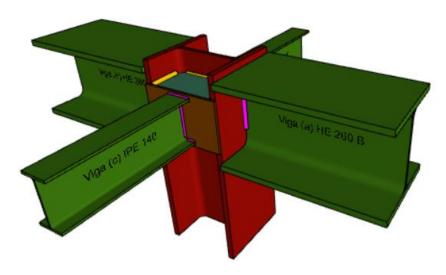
Unión encuentro pilar- cuatro vigas segunda planta. Fuente: CYPE 2019
